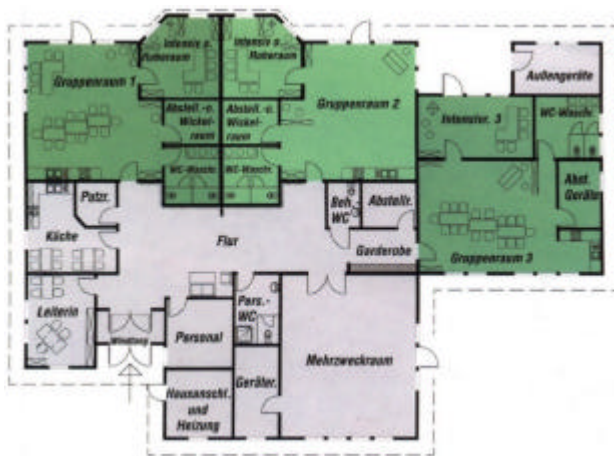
Grundrißvariante für Kindergarten der Firma „ALHO“
